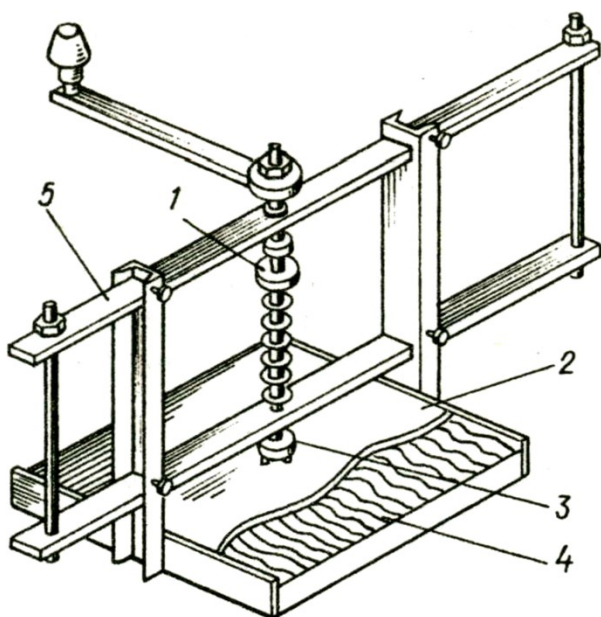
Пристрій для свердління отворів у плитках: 1 - робочий вал; 2 - плитка; 3 - різальний диск; 4 - дерев'яна основа з обмежувальними напрямними; 5 – каретка
